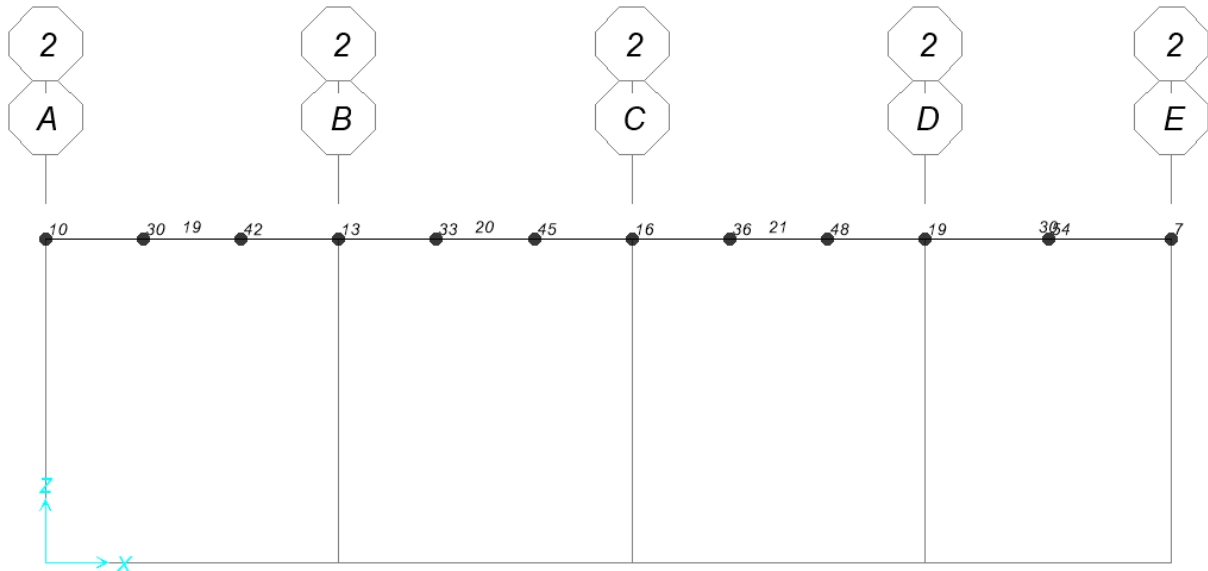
Vista in sezione modello struttura in elevazione –Filo 2 - numerazione elementi frame e joint
